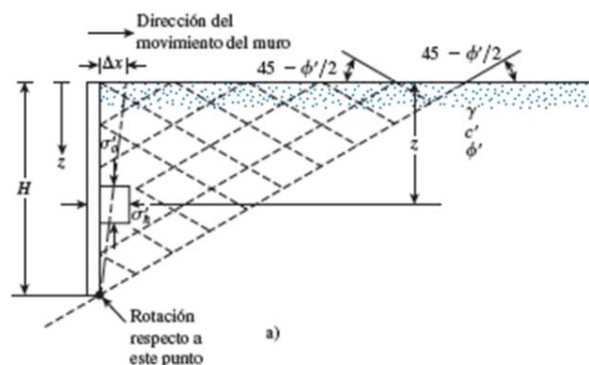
muro sin fricción se aplica esfuerzo horizontal
